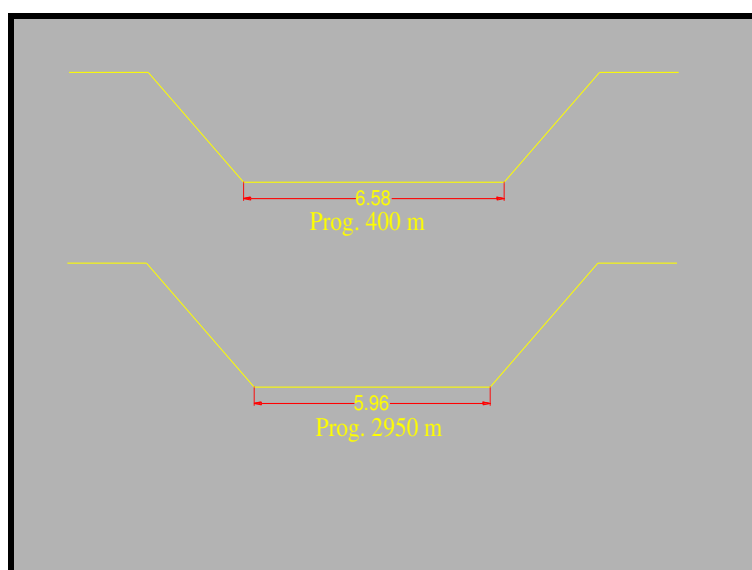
Perfiles transversales, canal Las Lomitas (Fuente: Jorge Ferreira)
